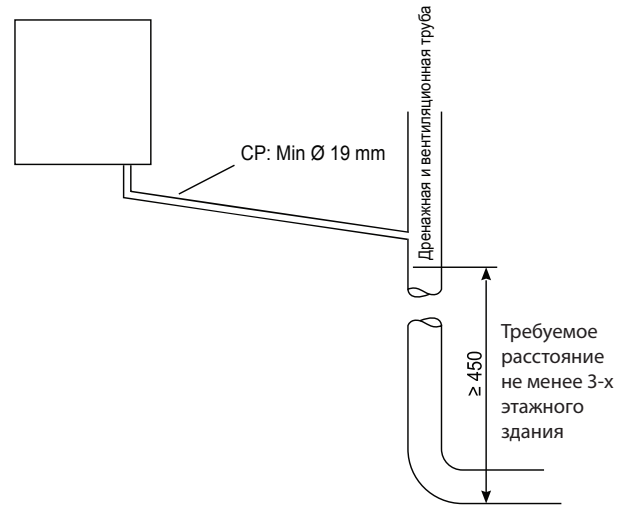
Соединение дренажной трубы к трубе для внутреннего слива и вентиляции
